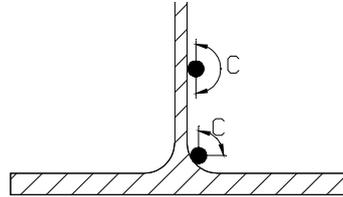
Perimetro efficace delle barre di armatura.
